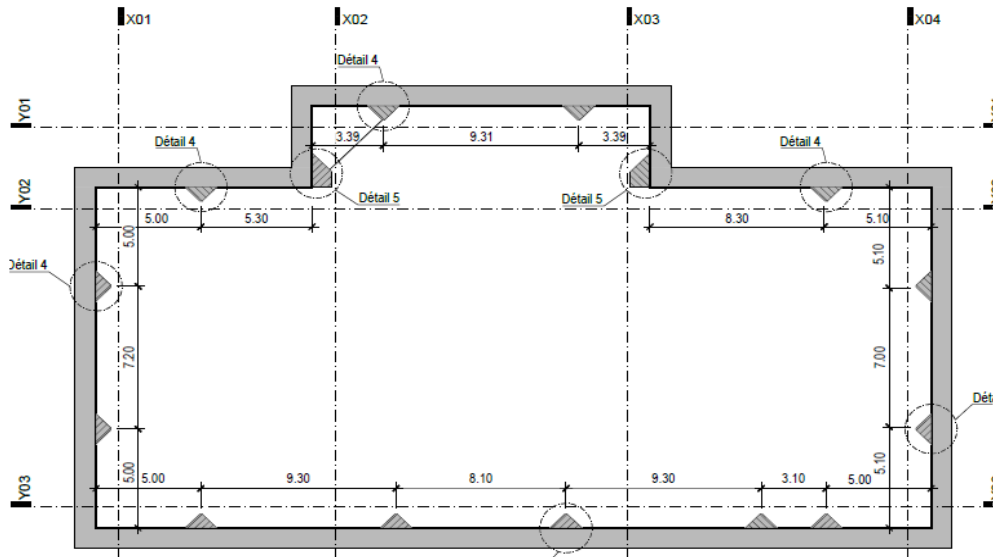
Vue en Plan Au Niveau +15.25 (Poutre 1 Et Massifs D'appui)
